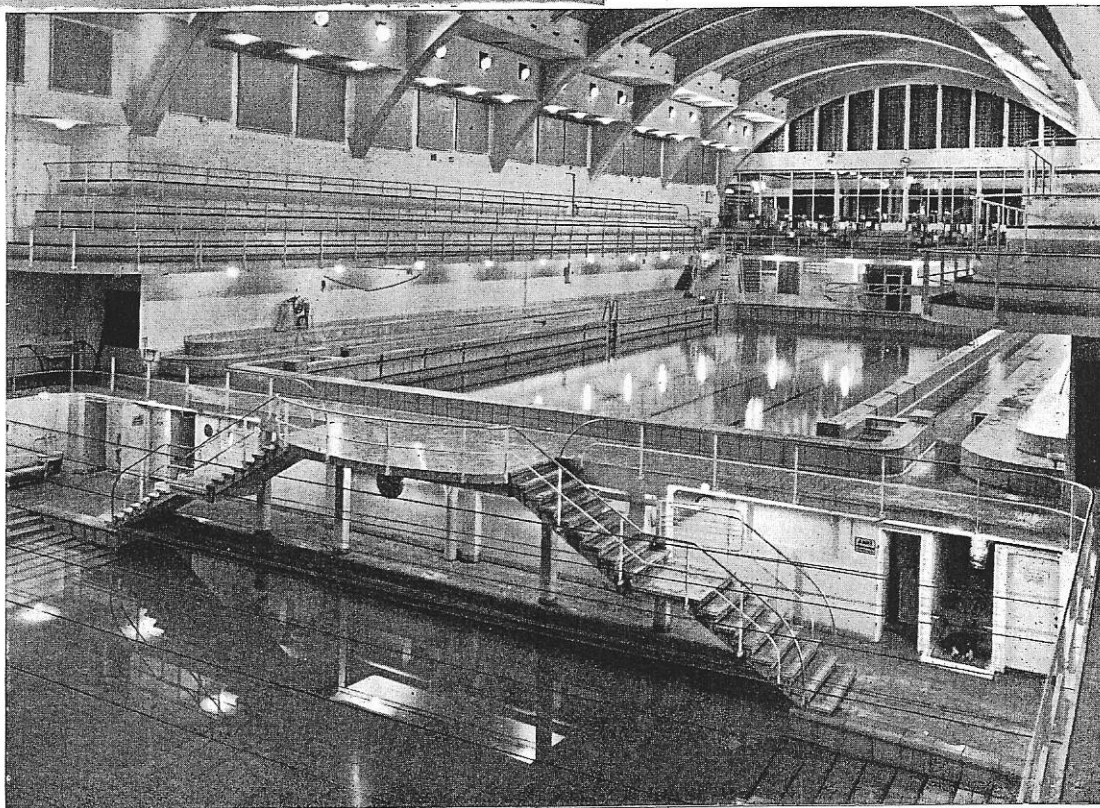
VUE D'ENSEMBLE DU GRAND BASSIN. Cette vue montre bien la disposition et l'ampleur des dégagements latéraux. Au premier plan, le bassin des scolaires; au second plan, le grand bassin; au fond, le restaurant.
